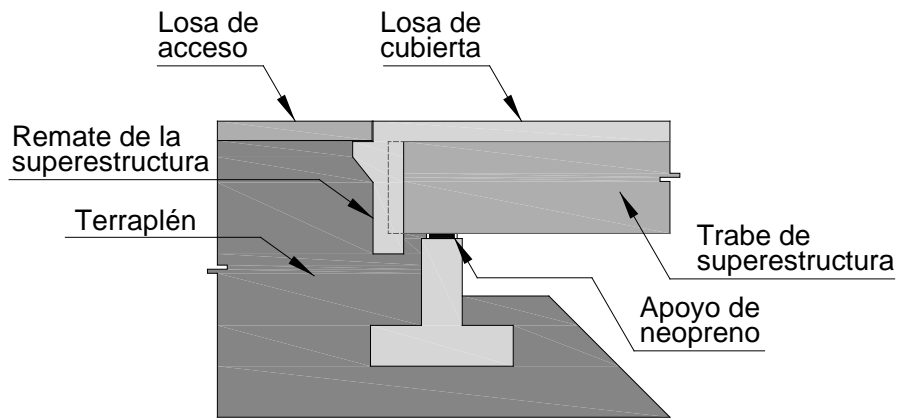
Estribo de puente integral- estribo de altura reducida
